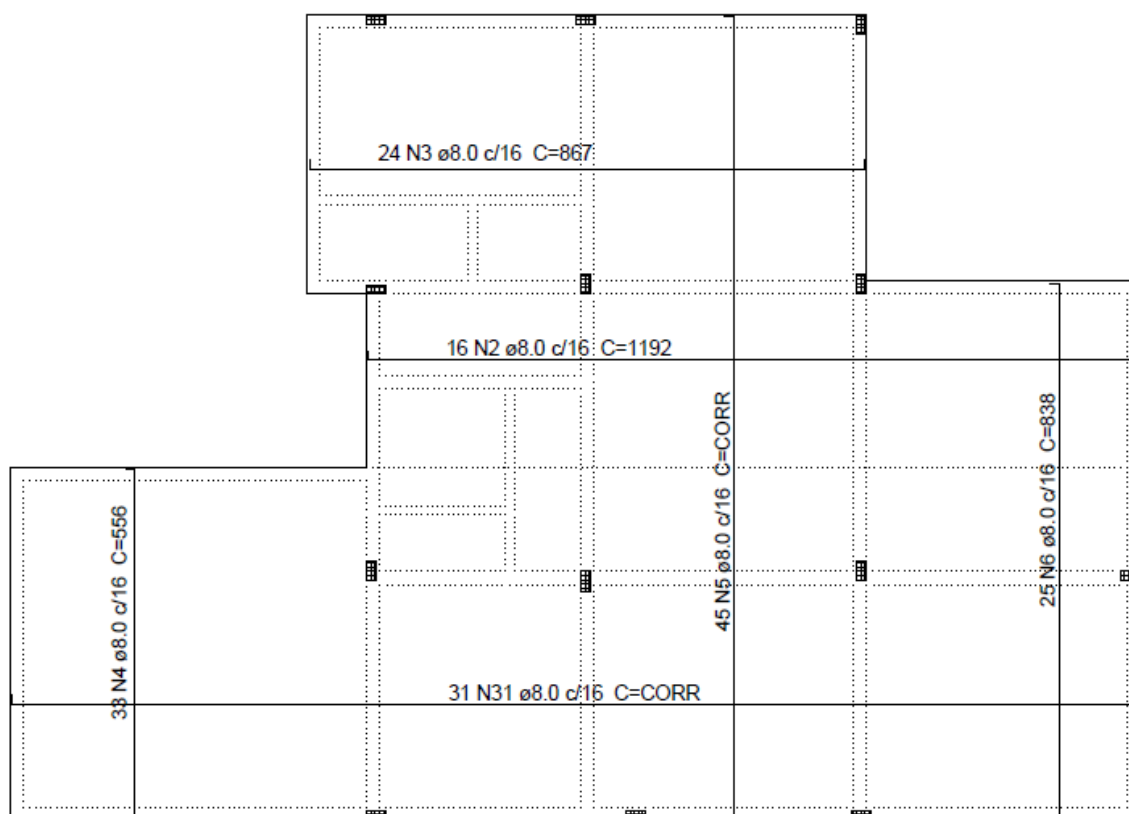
Detalhamento Armadura Negativa Dimensionada
